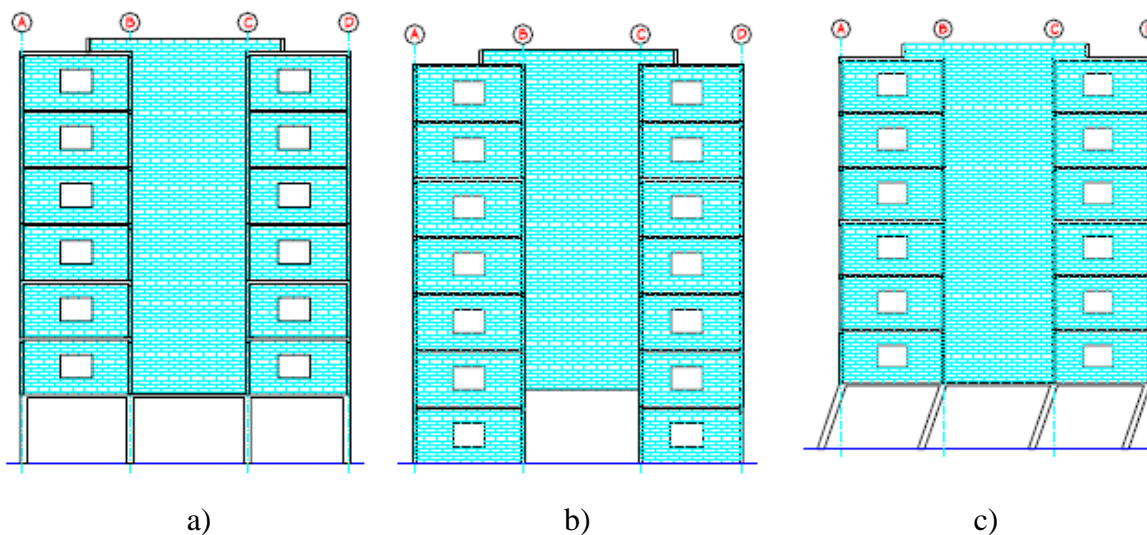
a) Edificio con planta baja débil, b) Variación de la planta baja débil, c) Modo de falla
